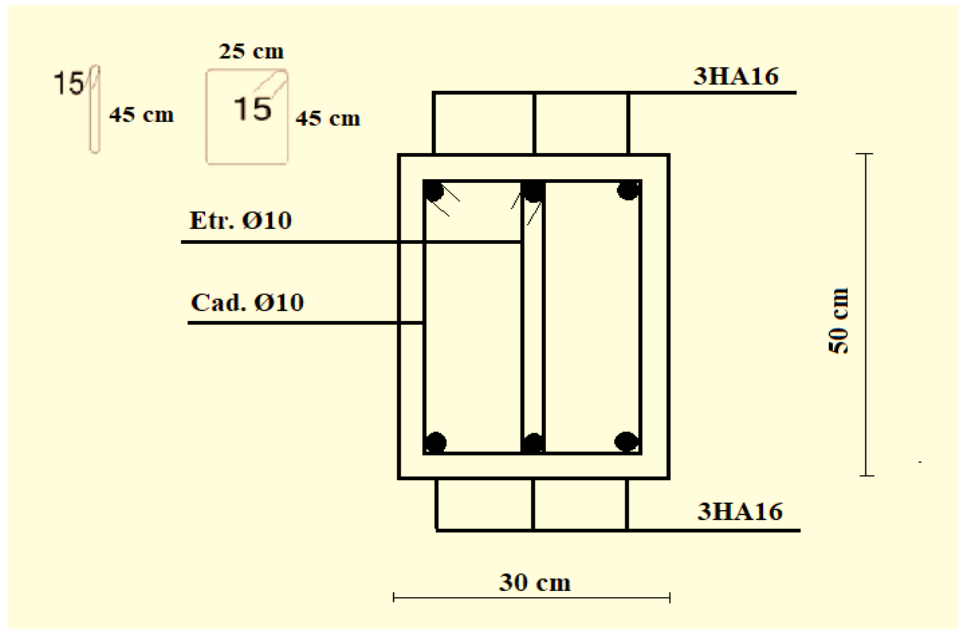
Ferrailage des poutres principales au niveau de la travée.
